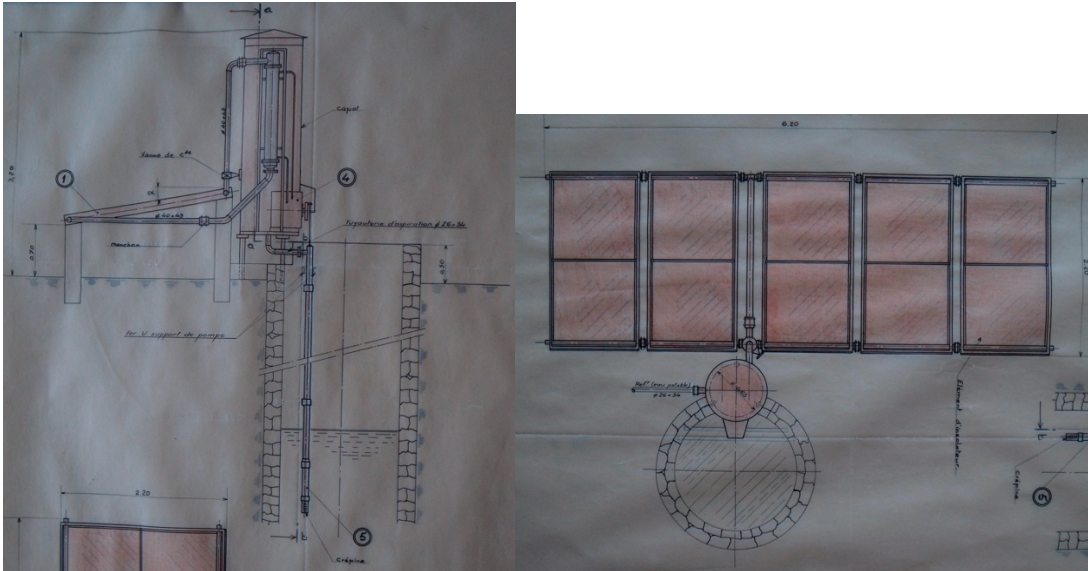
plan d'une pompe solaire sur puit équipée d'un moteur à gaz (à piston). Plan 21176, 15 décembre 1964, Archives privées fonds usine Mengin.
